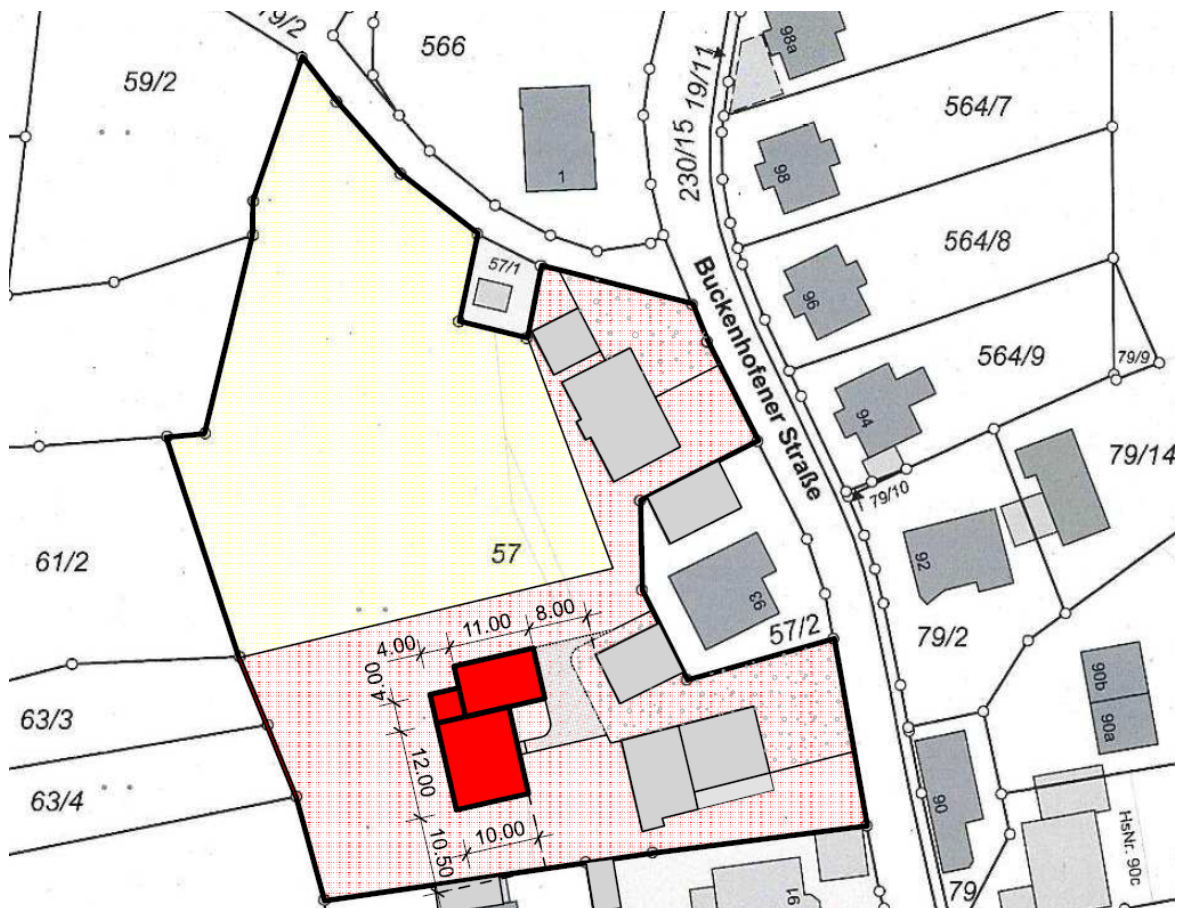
Lageplan gemäß Eingabeplanung vom Februar 2023
